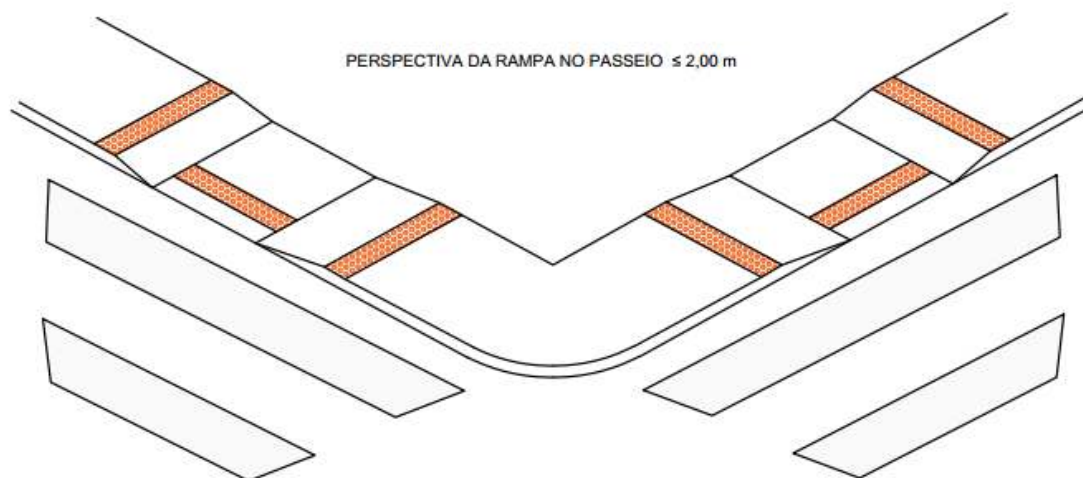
Rebaixo para acessibilidade Tipo 2 - Perspectiva.
